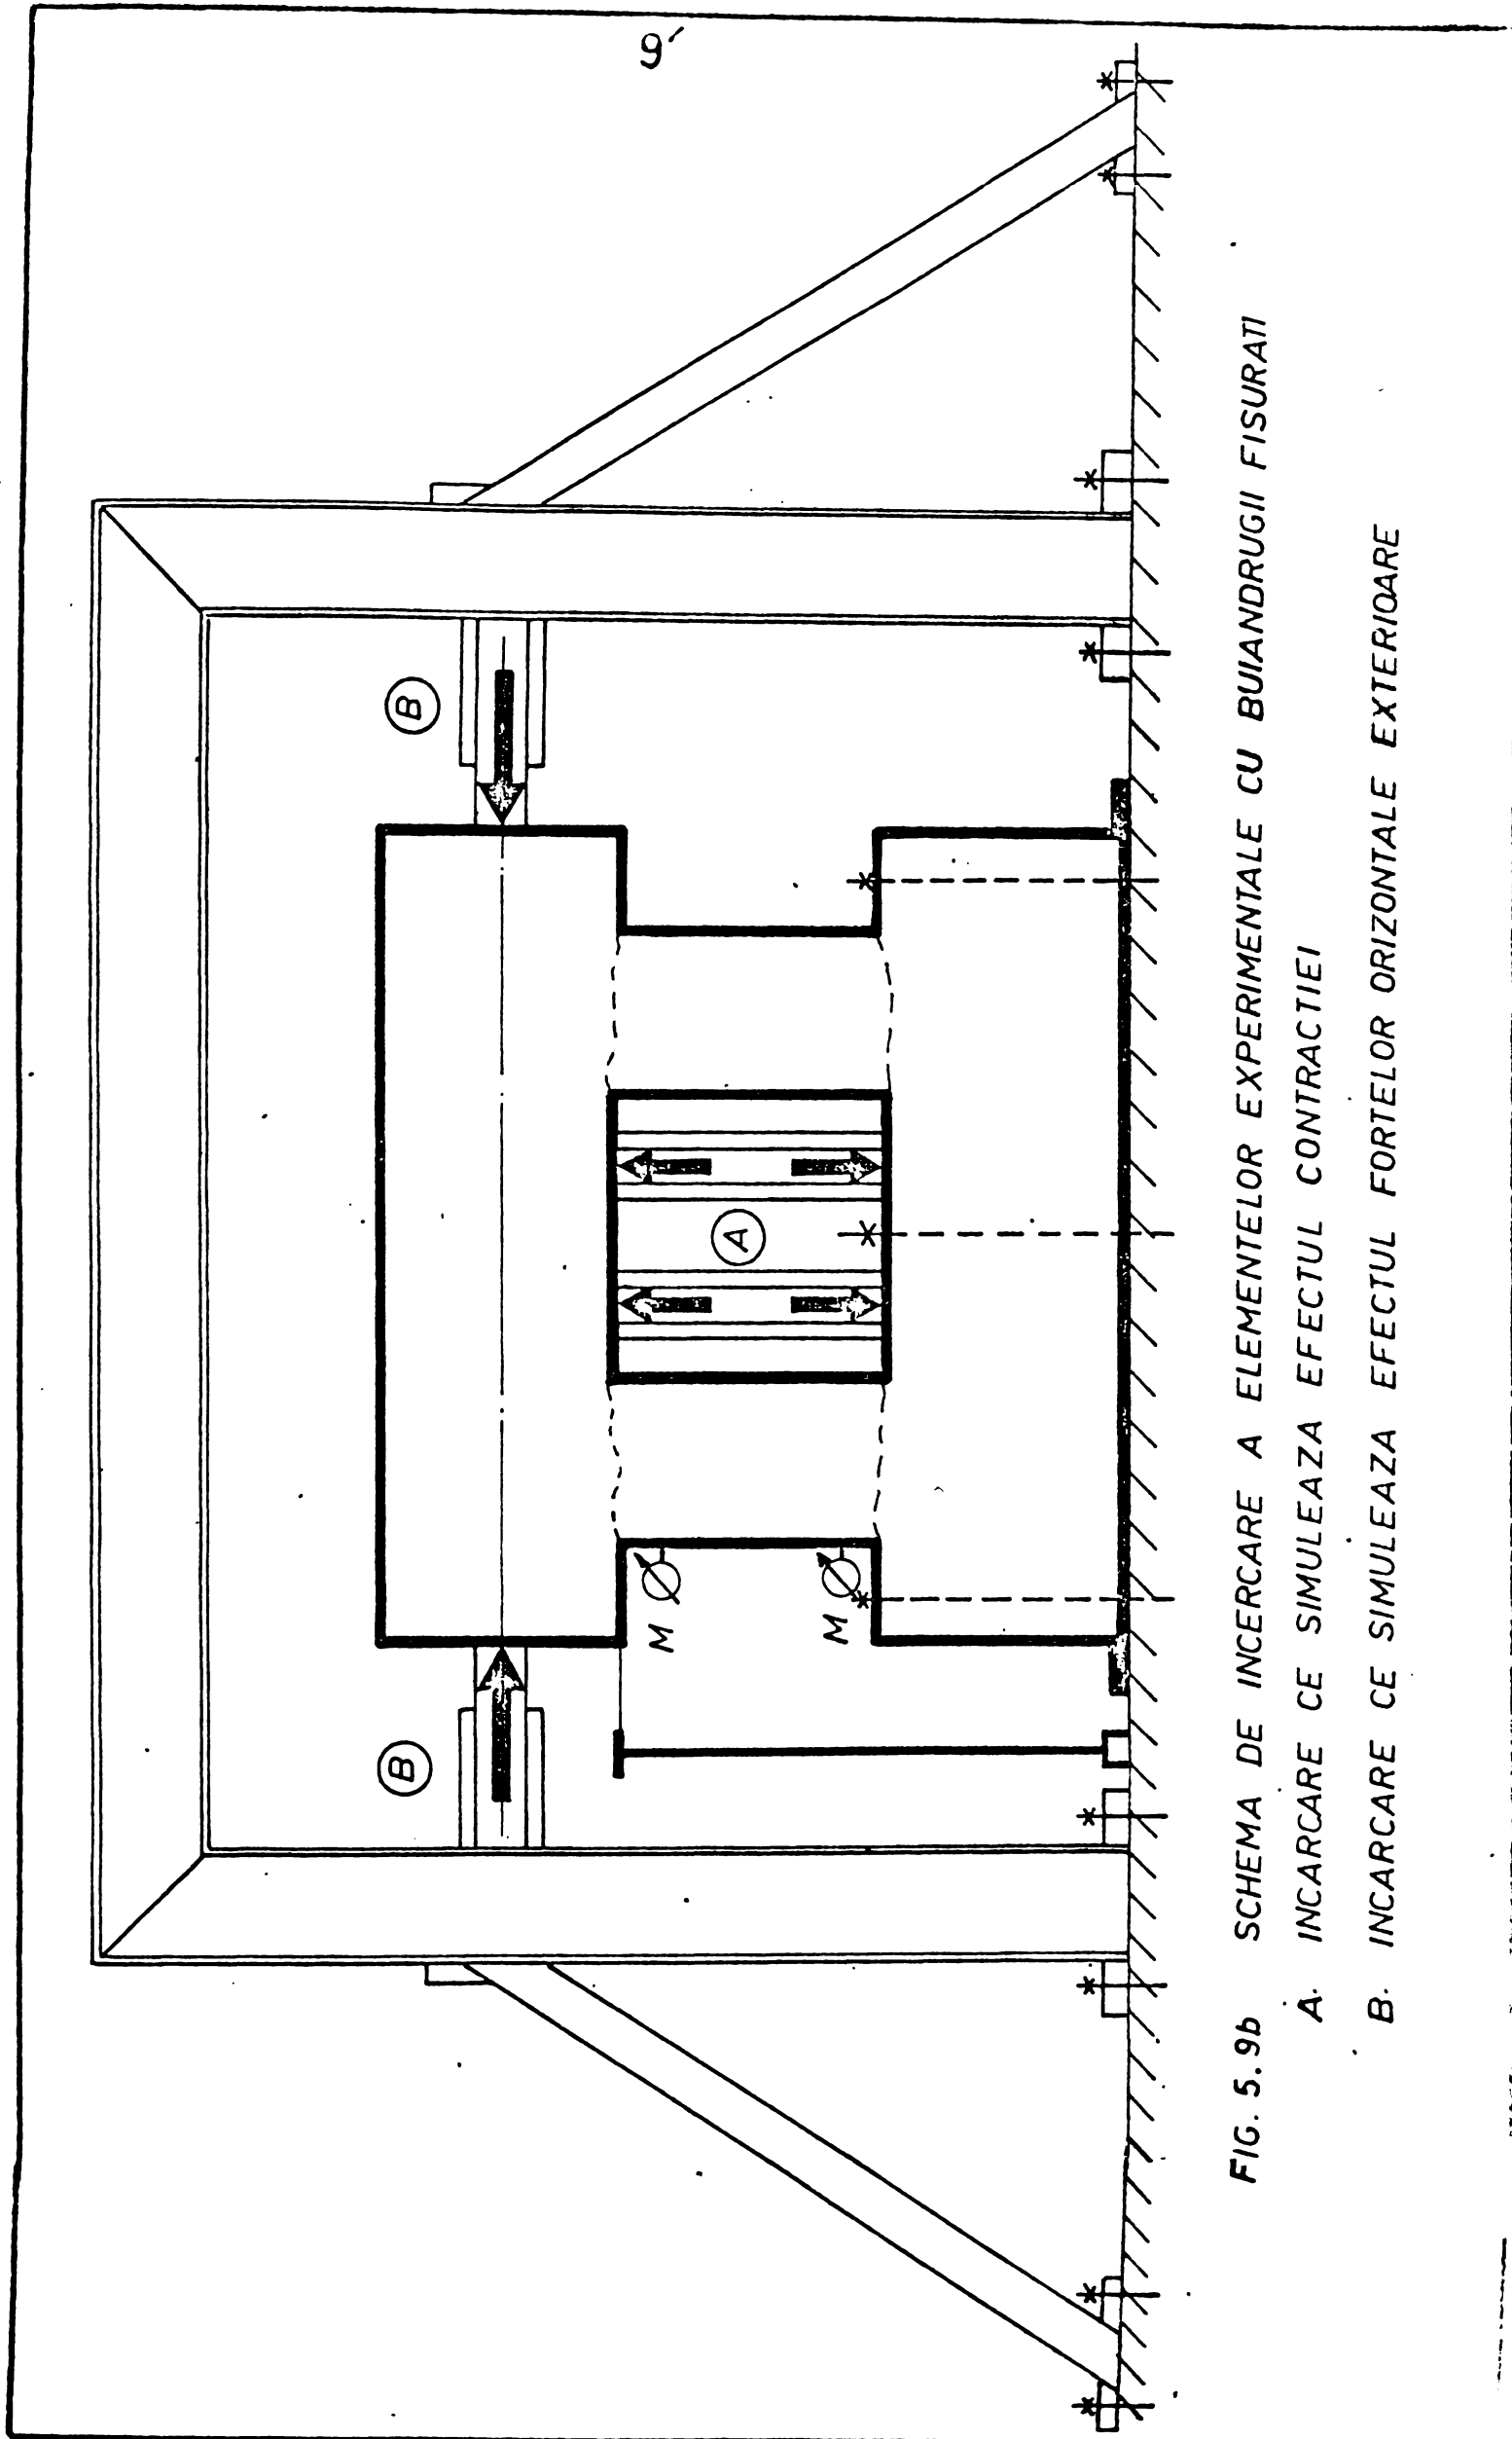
SCHEMA DE INCERCARE A ELEMENTELOR EXPERIMENTALE CU BUIANDRUGII FISURATI
